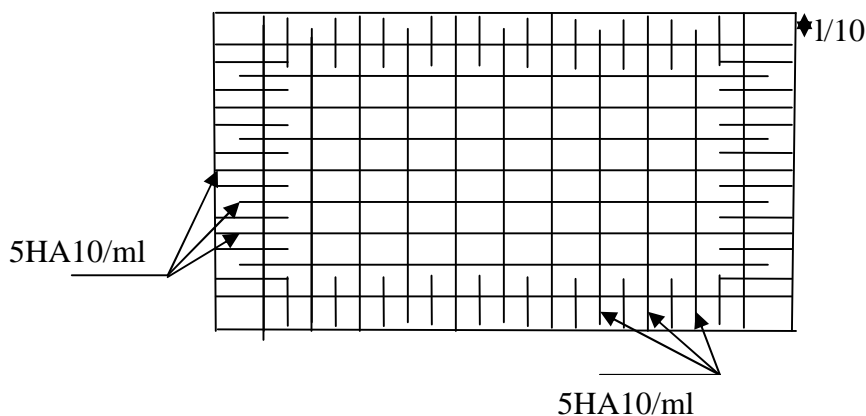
Vue en plans du ferrailage de la dalle de la salle machine
